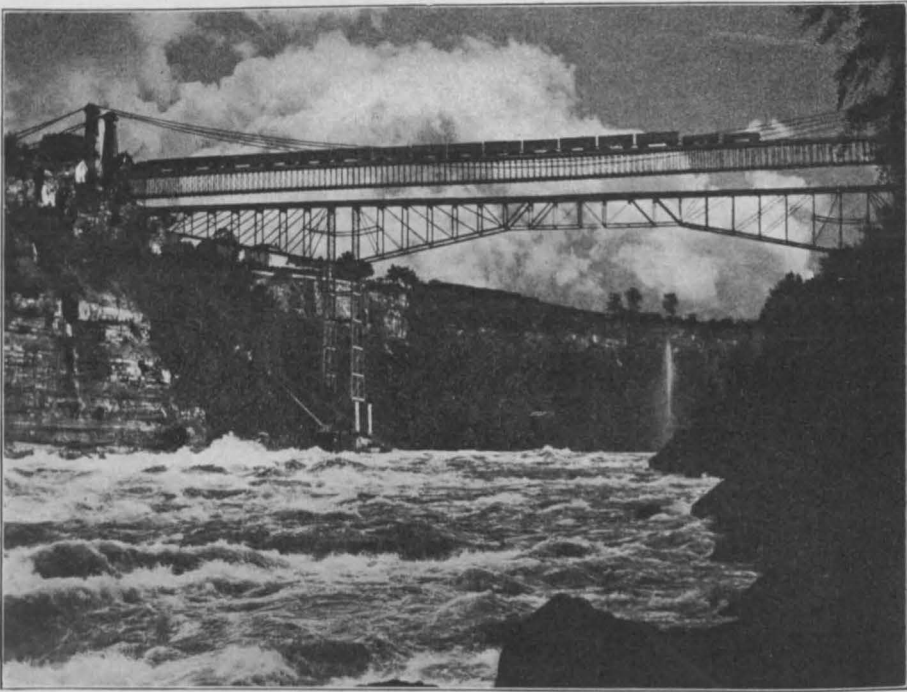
Niagara-Kabelbrücke. Erste Eisenbahn-Hängebrücke der Welt. 1855 eröffnet.
